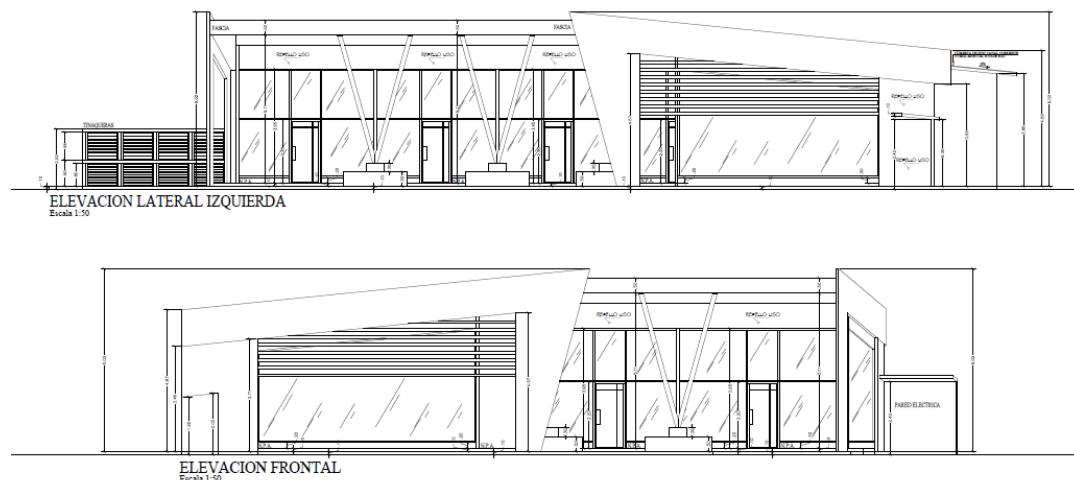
Vista elevación frontal y lateral izquierda de la plaza a construir. Fuente: Planos del Proyecto.
